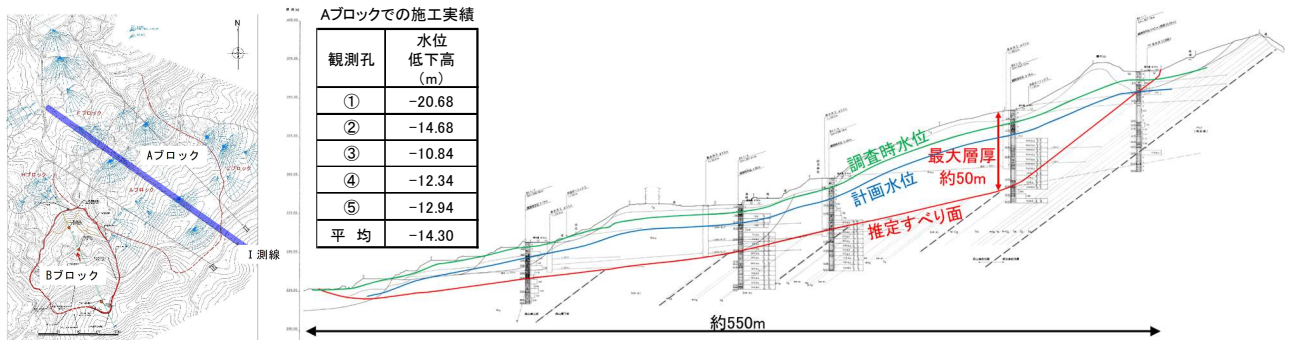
Aブロック平面図、断面図(I測線)、対策工施工実績
